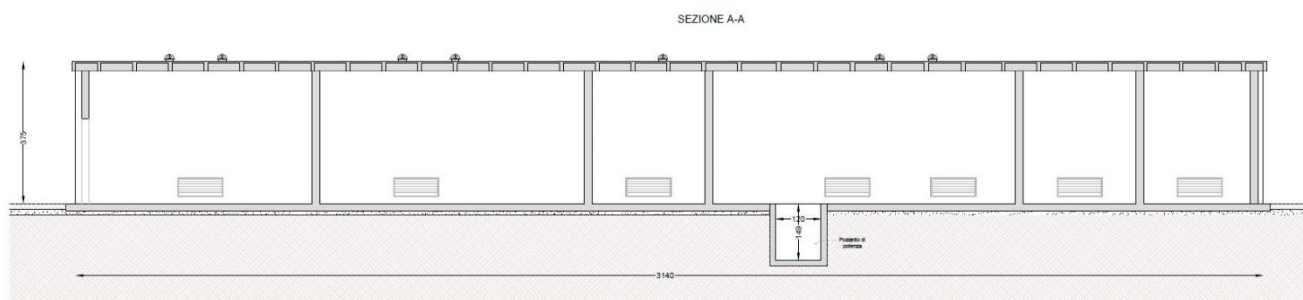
Sezione fabbricato stazione di utenza (misure in cm)
